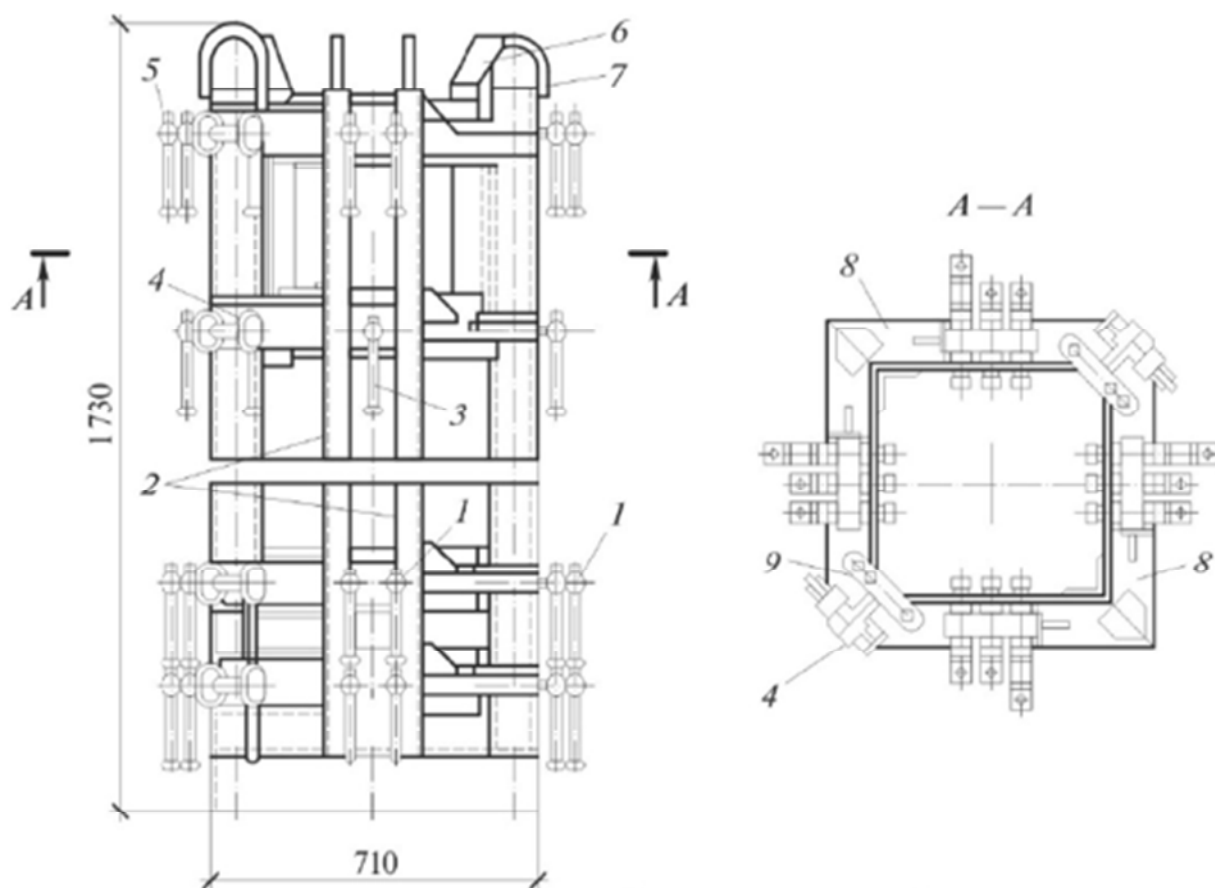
Одиночный кондуктор для монтажа колонн— разъемный со стяжными винтами: 1 — винты для крепления кондуктора к оголовку колонны; 2 — стойки кондуктора; 3 — винты для выверки низа колонны; 4 — стяжные винты; 5 — винты для выверки верха колонны; 6 — направляющие; 7 — монтажные петли; 8 — секции кондуктора; 9 — защелка;
